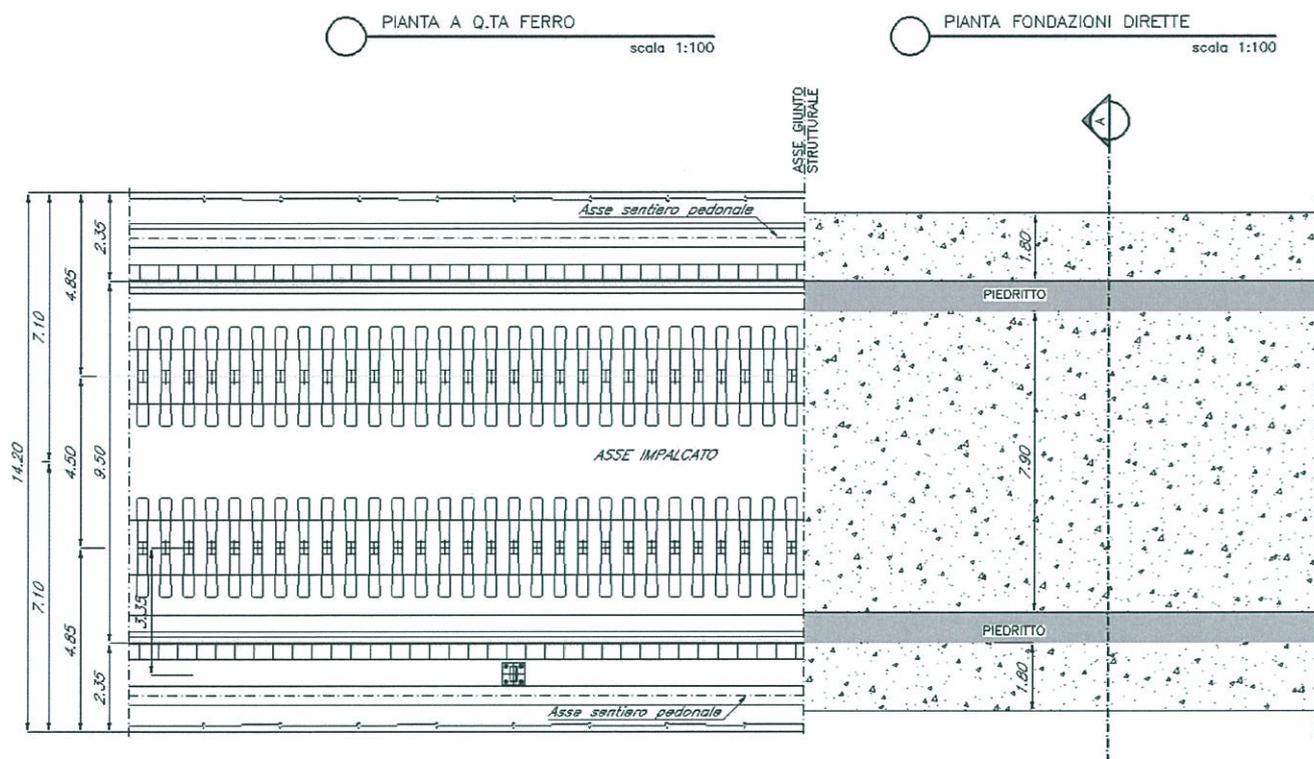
Pianta a quota ferro e pianta fondazioni dello scatolare.
